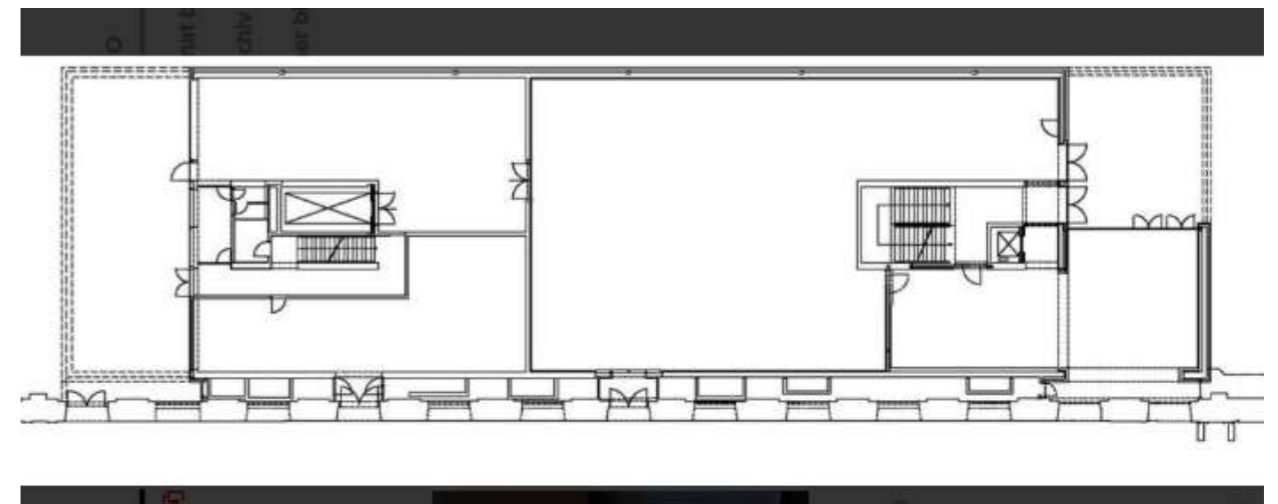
Österreich, Kunsthalle Wien, Grundriss
